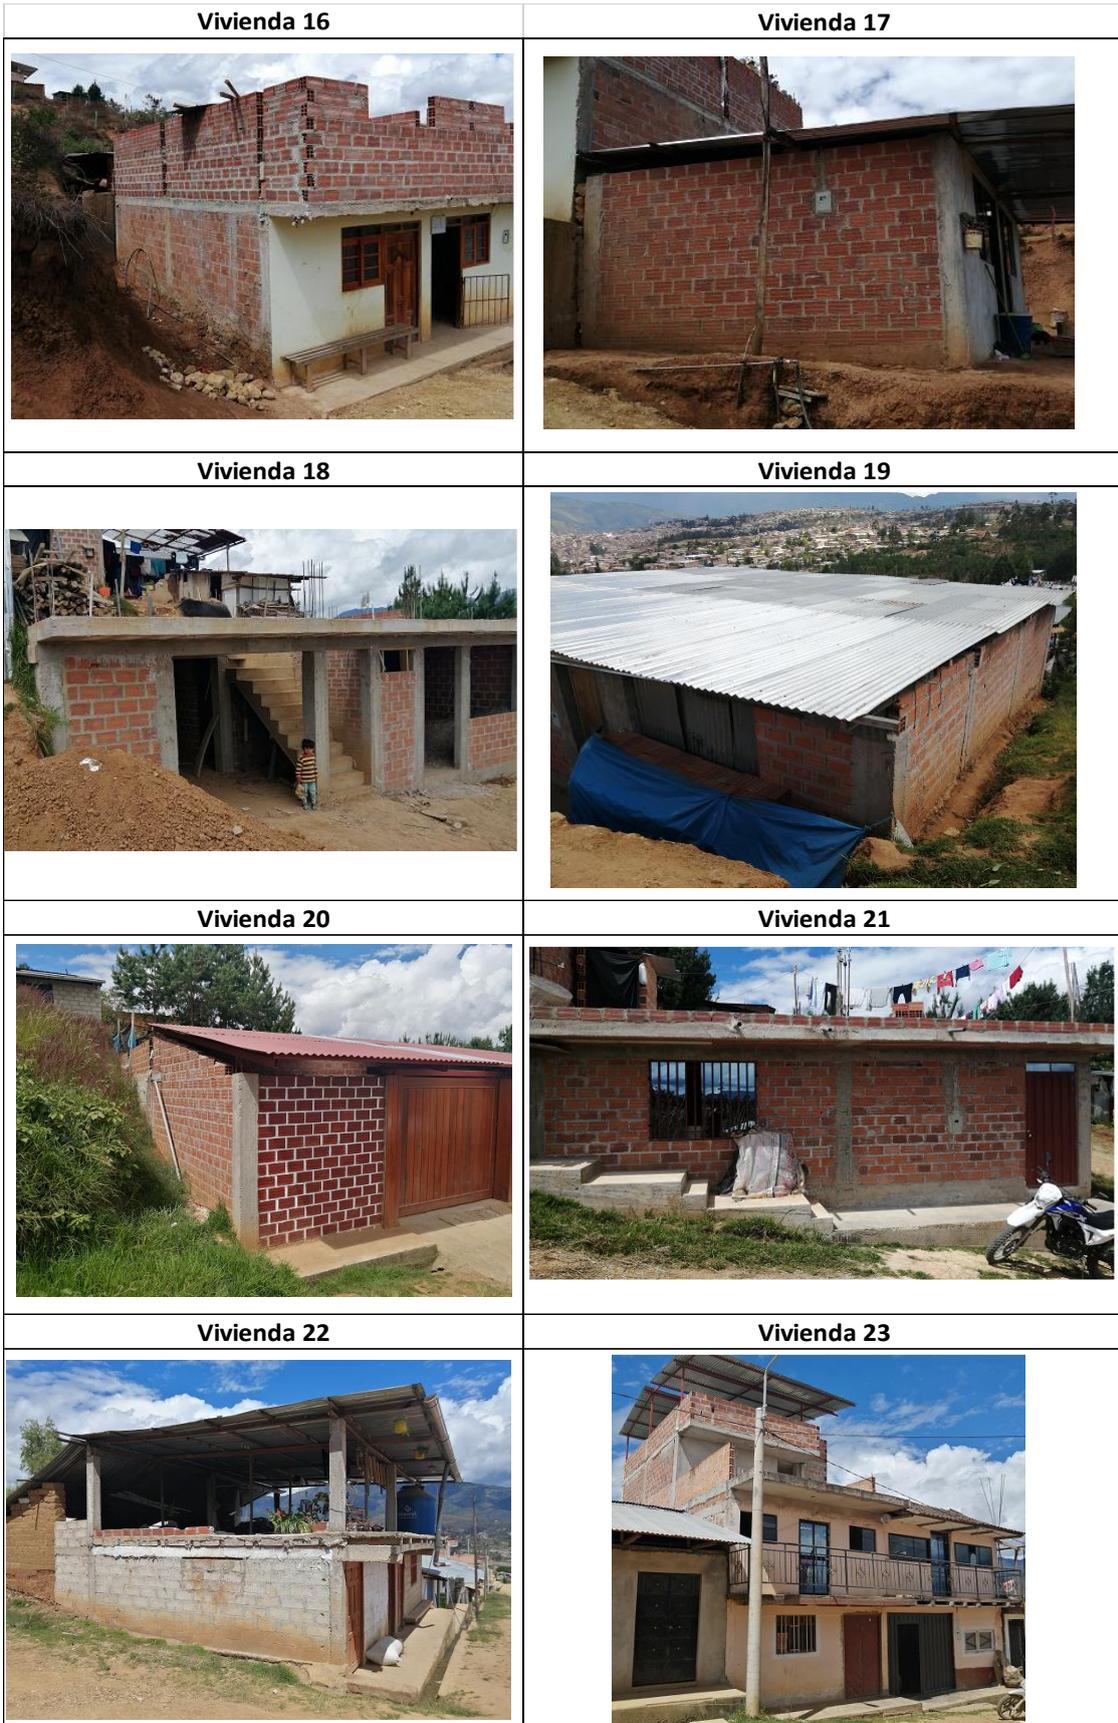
Fotos de las viviendas de Santa Rosa (16-23).
